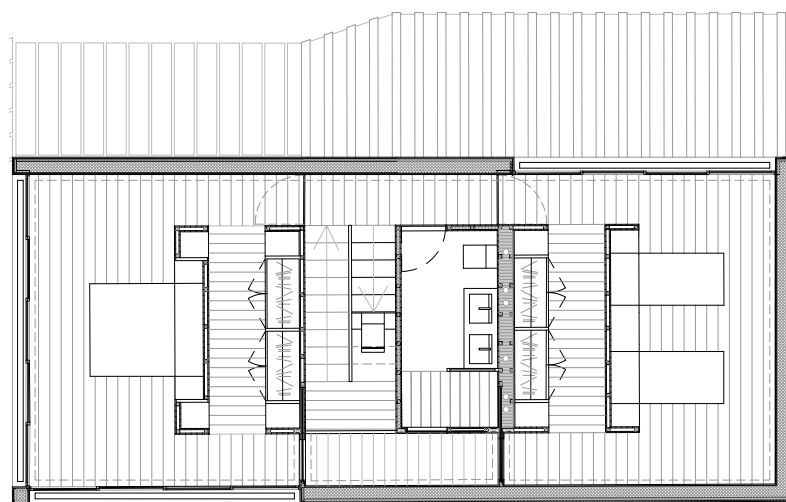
| Planta com detalhe do primeiro piso do fogo. Imagem de autor.
